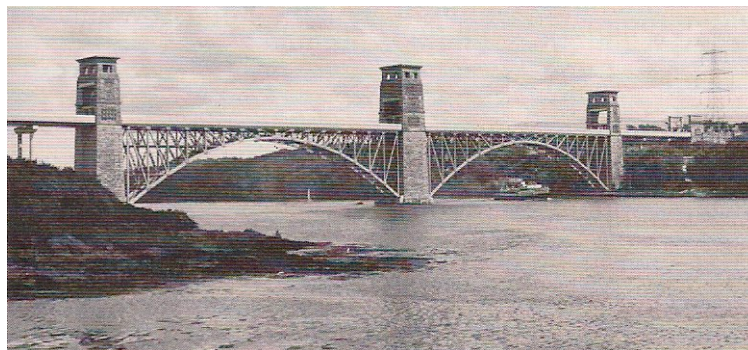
Ponte Britannia reconstruída depois do incêndio
